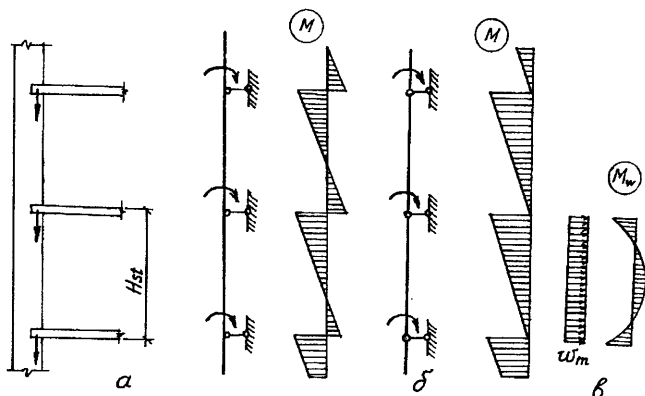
Расчетные схемы стены (столба) и опоры изгибающих моментов от вертикальных внецентренно приложенных и горизонтальных нагрузок: а - при расчете как неразрезной балки; б - как однопролетной в пределах высоты этажа; в - от ветровой нагрузки
